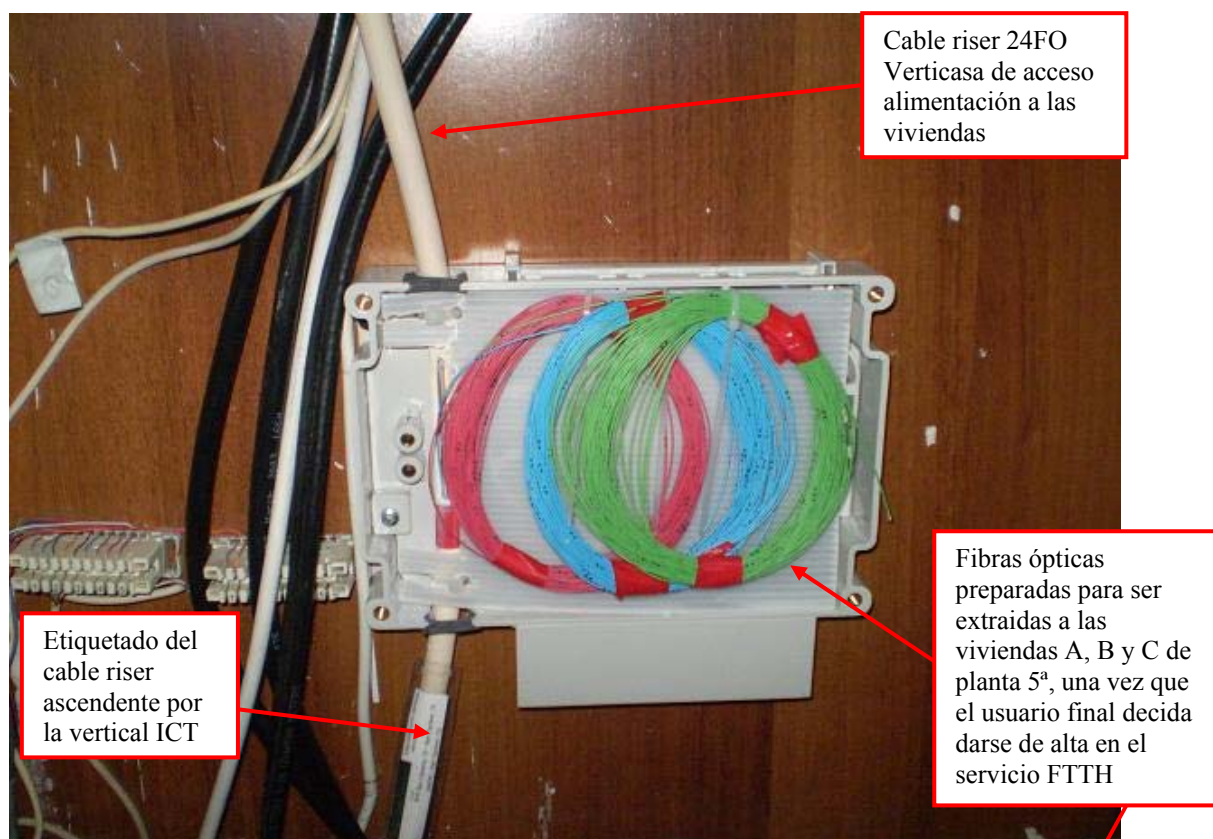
Vista exterior de caja Riser Box Verticasa, de derivación de planta 5ª
